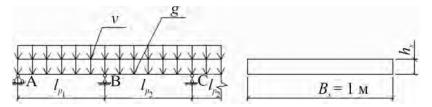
Расчетная схема плиты и расчетное сечение: g — расчетная постоянная нагрузка; v — расчетная временная нагрузка; q = g + v — полная нагрузка
